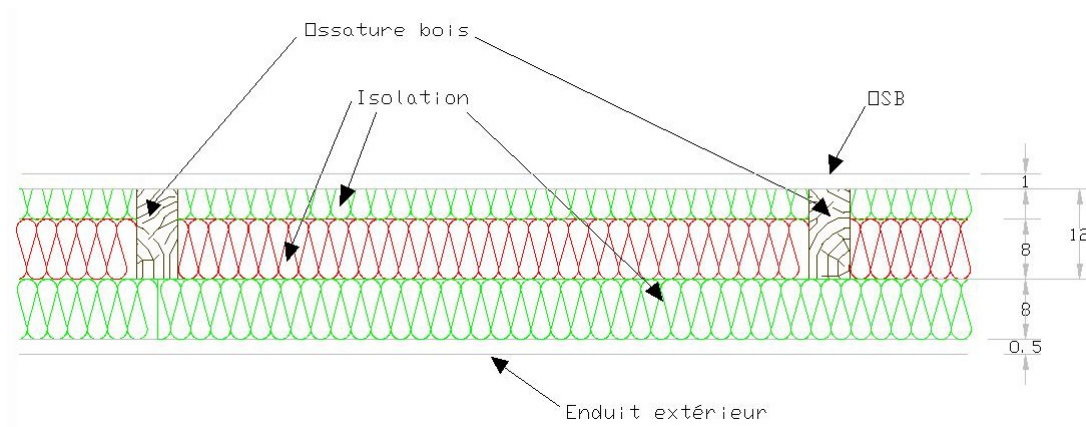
Coupe de la paroi modifiée, Phase 2 (Unité : cm)
